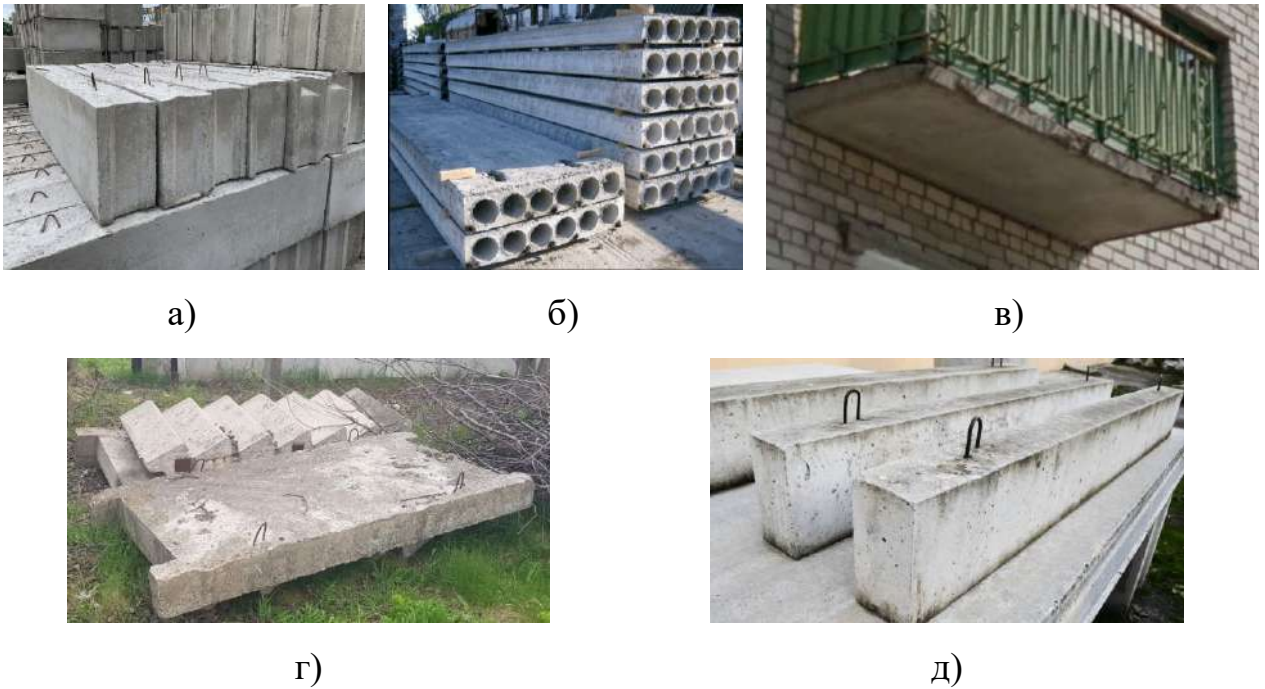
Типові збірні бетонні та залізобетонні конструкції, що застосовувалися в будівництві житлових будинків масової забудови в 1950-70 х р.р.: а – фундаментні блоки типу ФБС; б – круглопустотні плити перекриття та покриття; в – балконні плити; г – сходові марші та майданчики; д – брускові перемички
